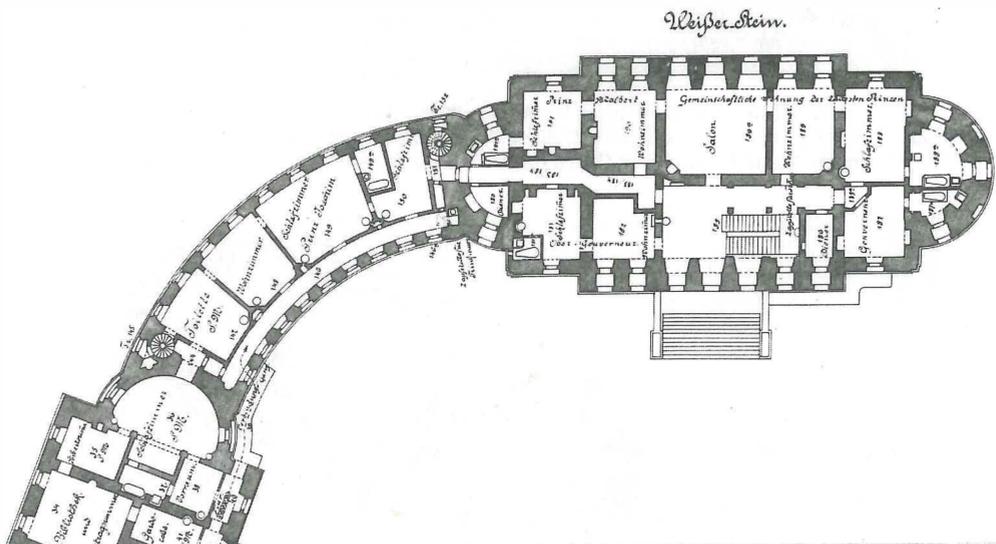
Schloss Wilhelmshöhe, Grundriss, nach 1894, Ausschnitt: Weißensteinflügel mit Zwischenbau SPSG, Plankammer Potsdam, Plansammlung, Inv.-Nr. 19682 (Foto: Lindner 2007)
